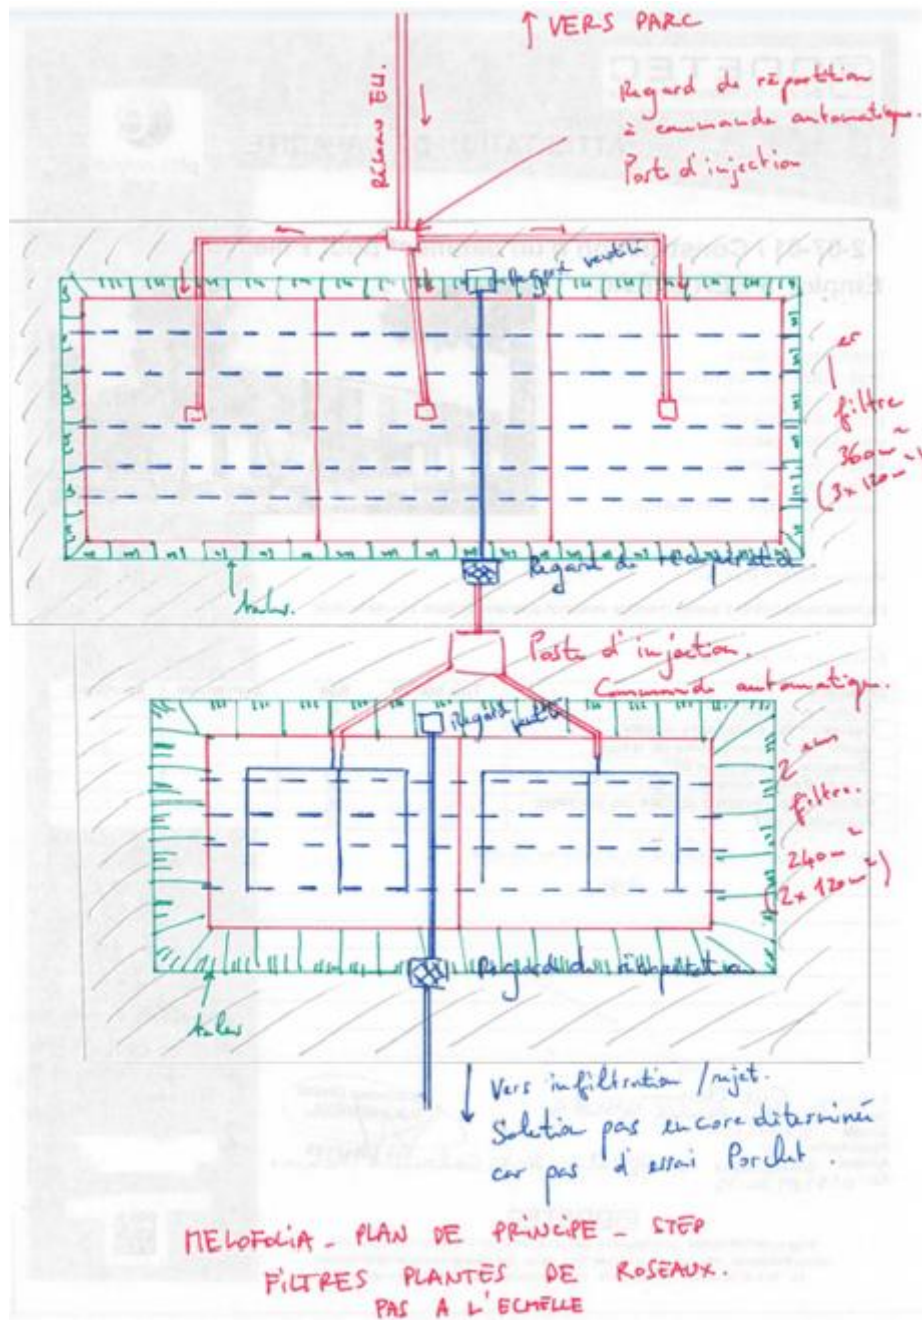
Fonctionnement général de la STEP : plan de principe (Source : Notice explicative – STEP en filtres plantés en roseaux – complément, mai 2023)
